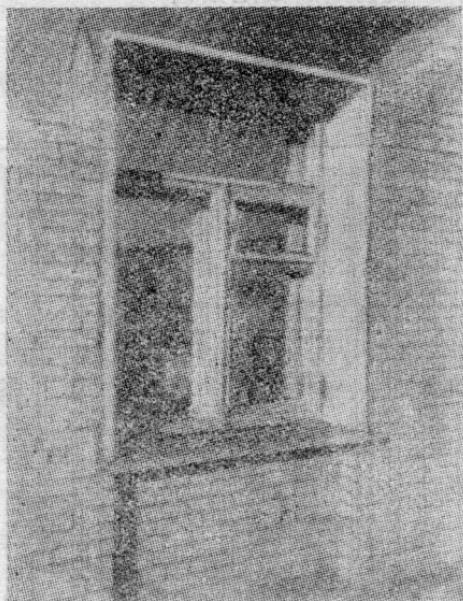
裝配式鋼筋混凝土窗砌塊全視圖
